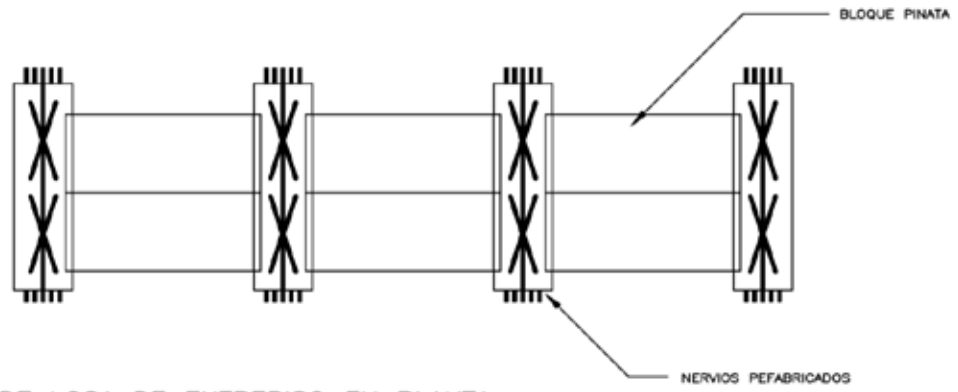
Detalle de losa que se utilizó en entrepiso y techo. (2016)
